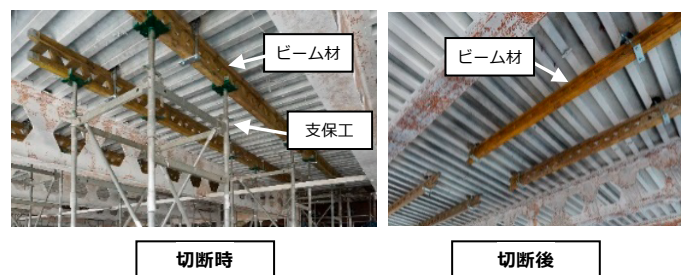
切断前後のスラブ下部状況 (Slab Lower Condition Before and After Cutting)
